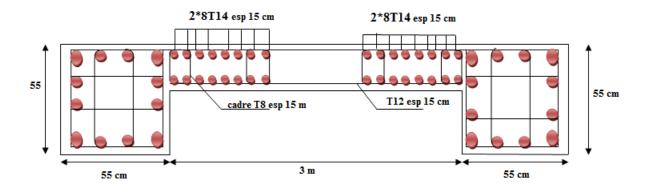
Détail de Ferraillage du voile (V2- V2'), coupe horizontale.
